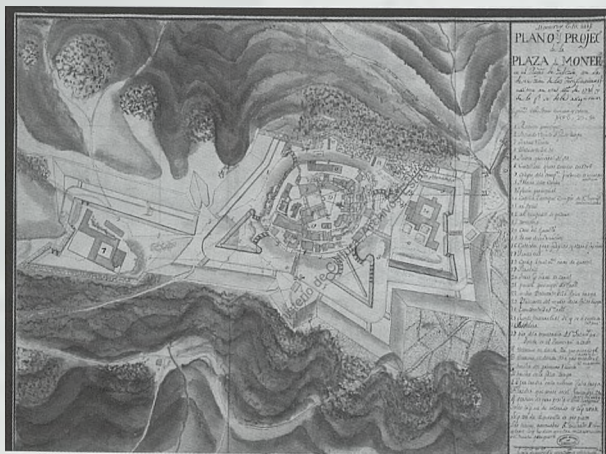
Proyecto de 1726 para Monterrey realizado por el ingeniero Francisco Montaigut
